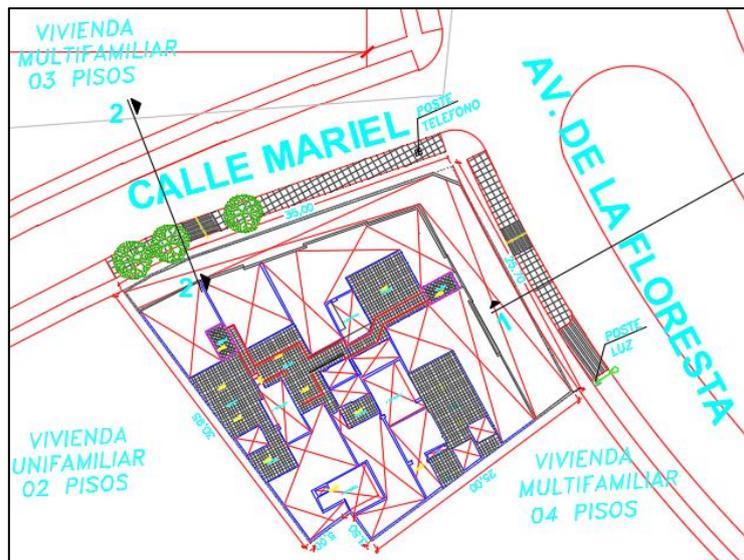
Ubicación en planta del Proyecto Floresta VI.
